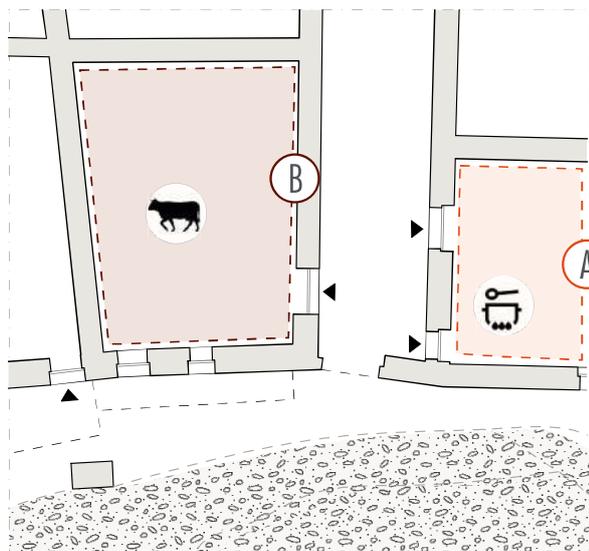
/8. Schematizzazione prospettica e planimetrica degli edifici 010, 011 e 021
